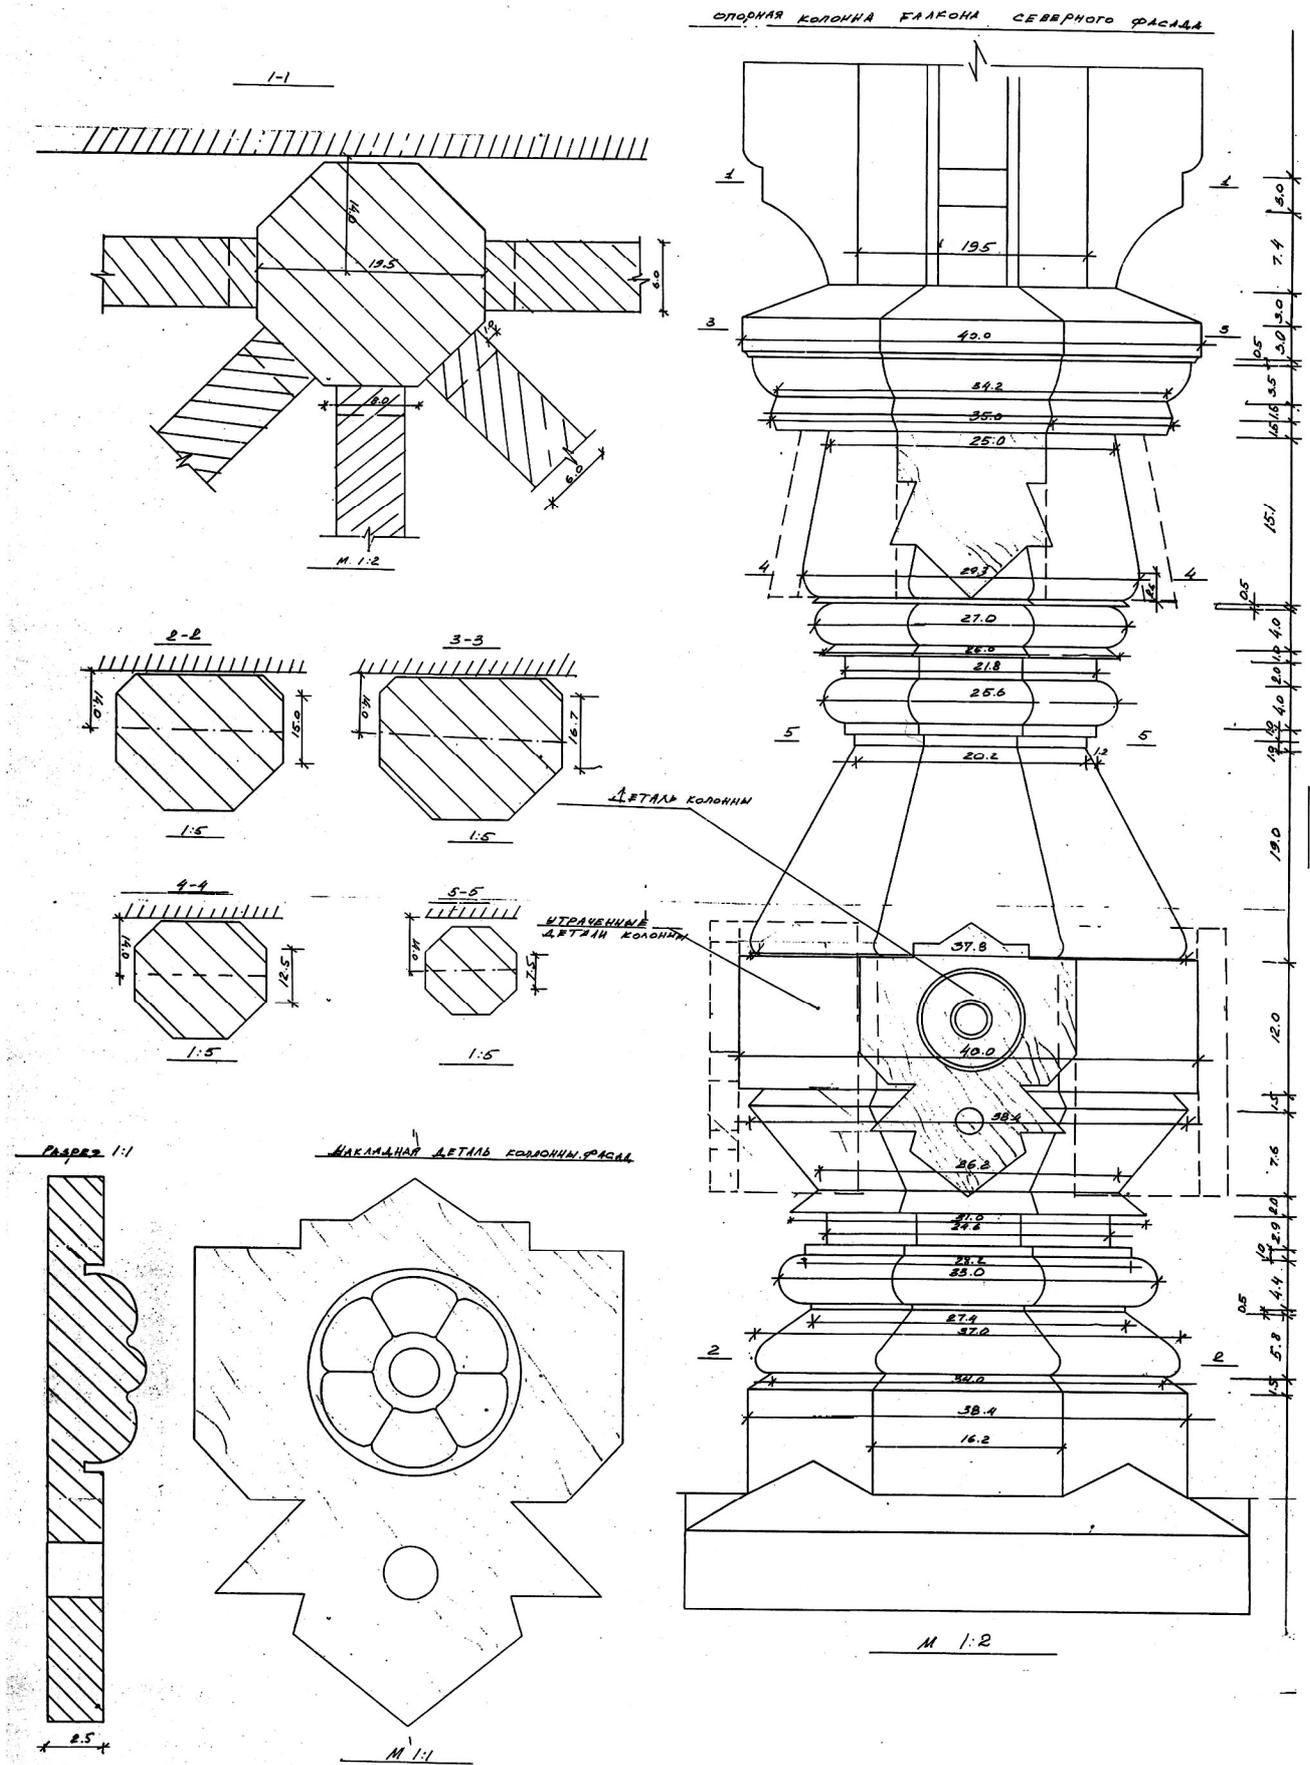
Колонна под балконом на северном фасаде дачи. Фасад, профили.
